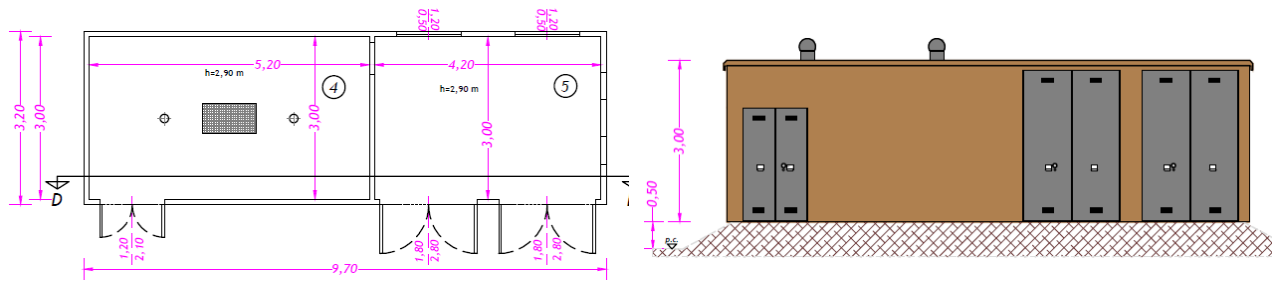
Pianta e profilo delle cabine MT/BT “1.A”, “1.B” e “2.A”
